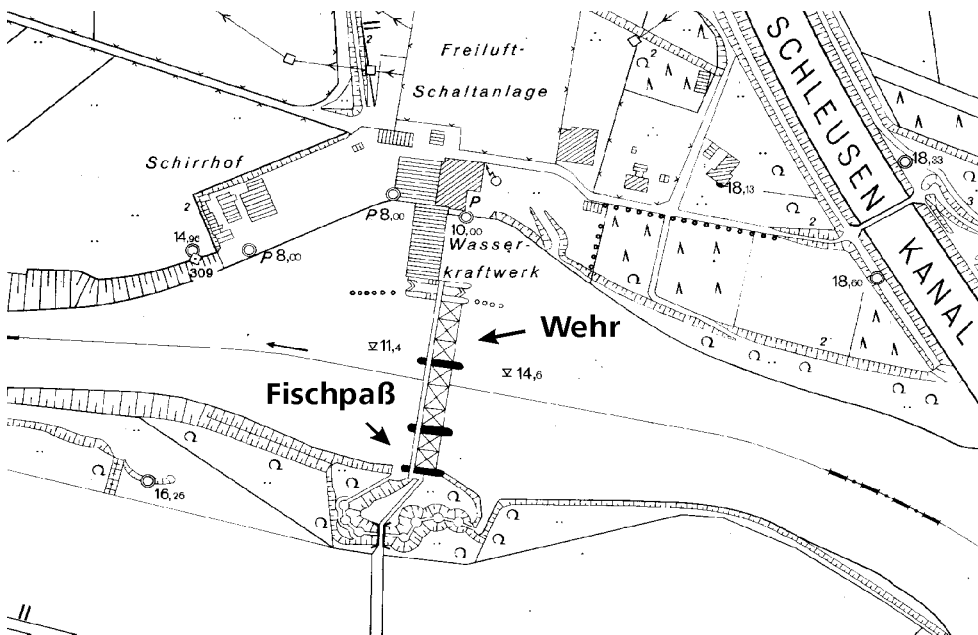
Lageplan der Wehranlage Dörverden
